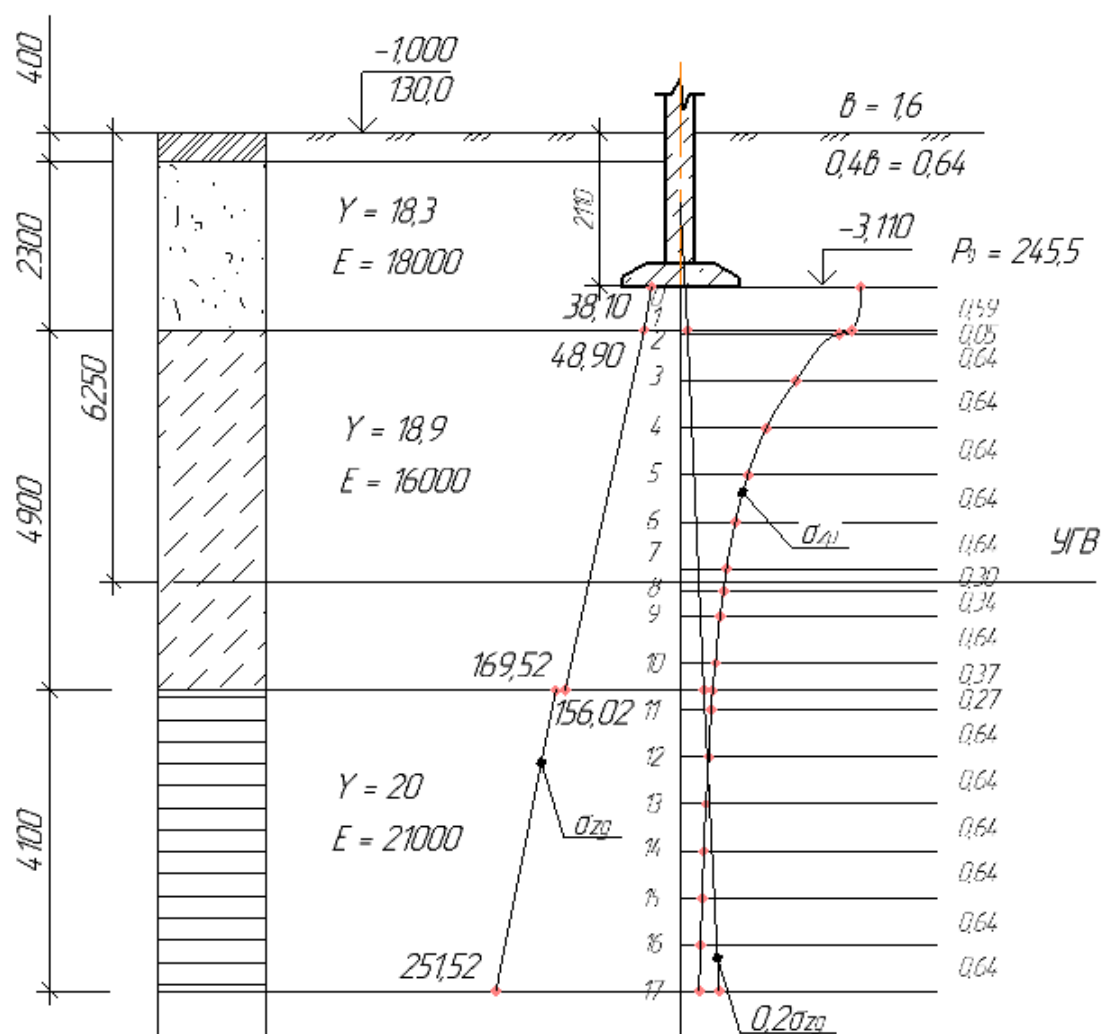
Схема расчета фундамента методом послойного суммирования
